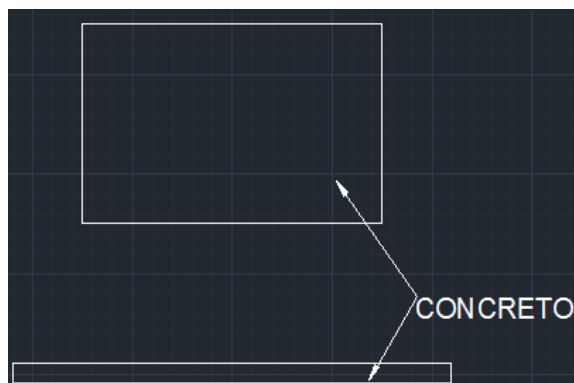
Esquema viga equivalente transformada a un solo material (concreto).
